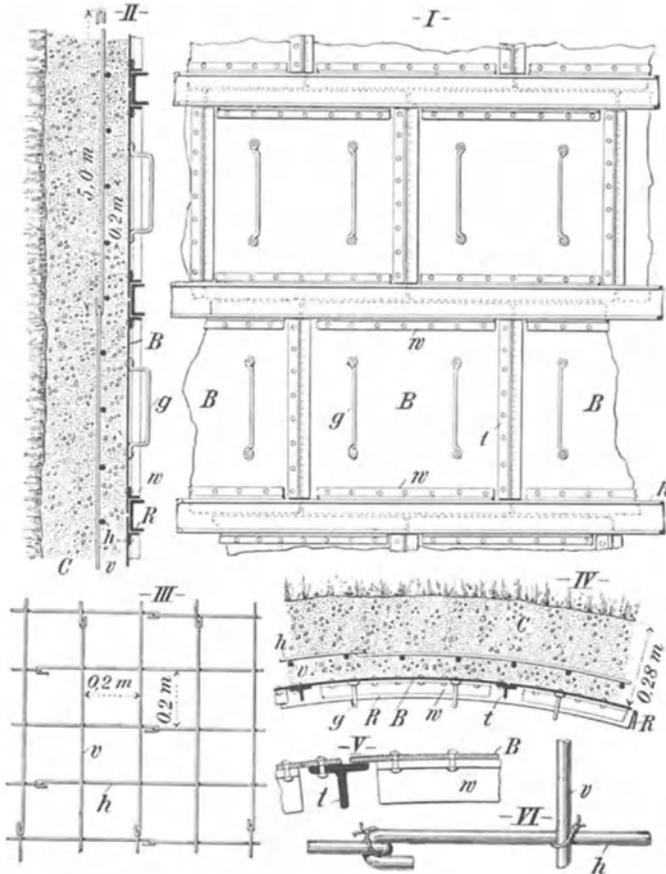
Schachtausbau mit Eisenbeton unter Verwendung eines Lehrgerüsts.
